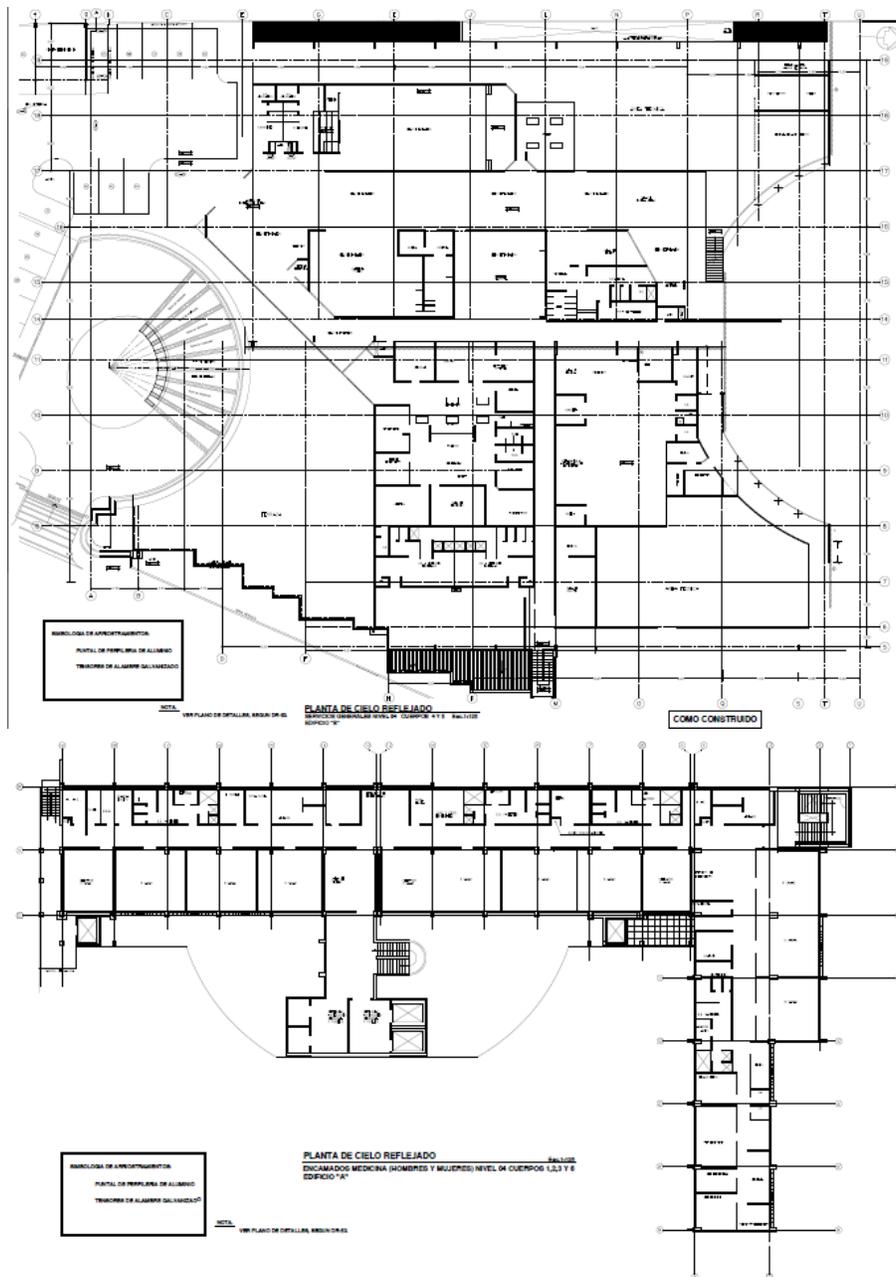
Arriba esquema plano edificio B. Abajo esquema plano edificio A
